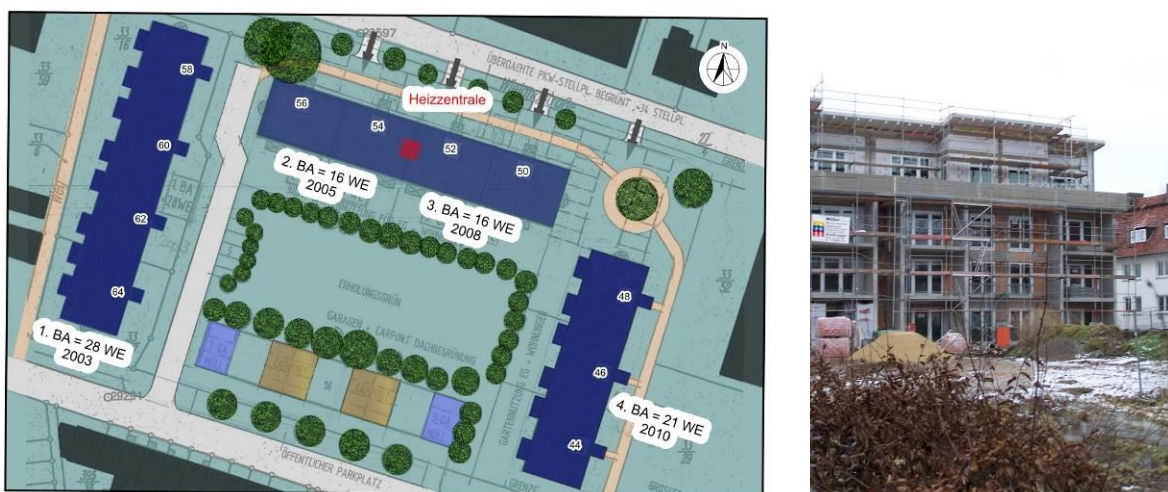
Links: Lageplan Brentanostraße, Rechts: Süd-Ansicht Rohbau Brentanostraße 54
